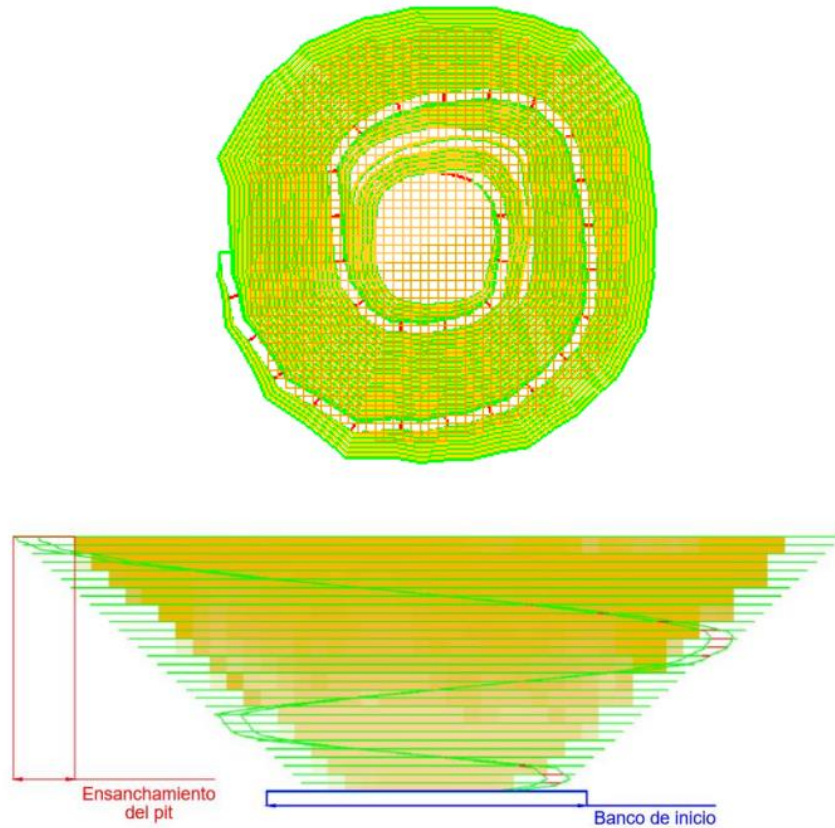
Diseño de rampa en corte, vista planta y lateral (Cerón, 2019).
